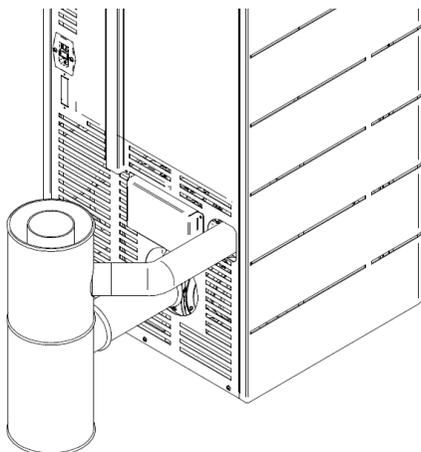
Encaixe T de inspeção coaxial e com um aumento tramo horizontal
